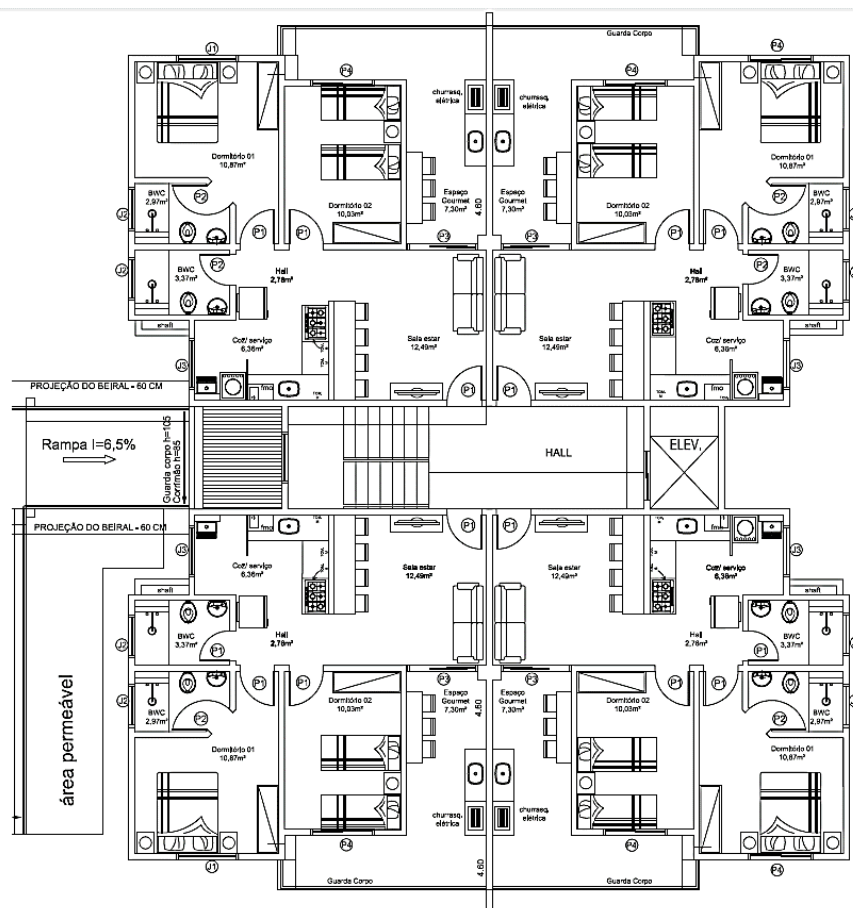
Planta tipo do pavimento térreo (Edifício térreo + 4 pavimentos).
